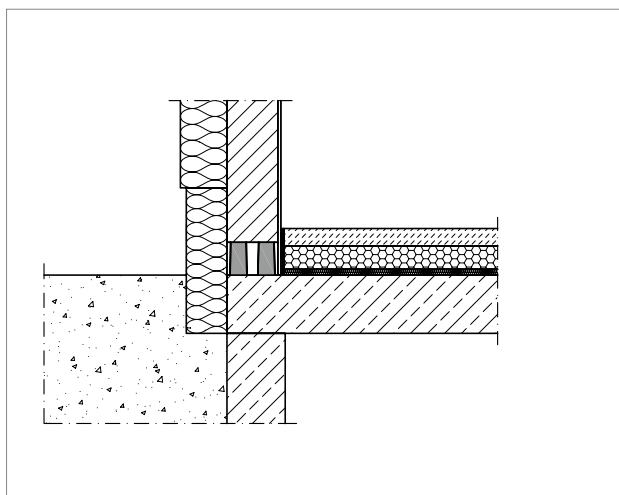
Effiziente Wärmedämmung mit Schöck Sconnex® Typ M
